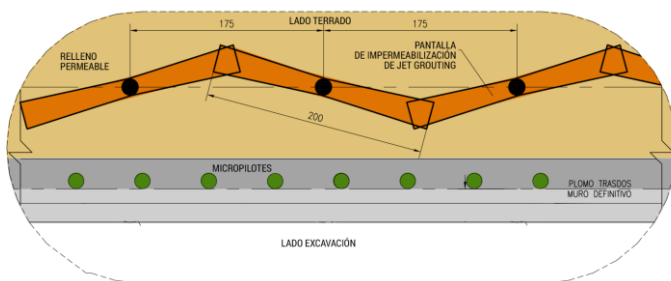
columnas de Jet Grouting como barrera de baja permeabilidad.
